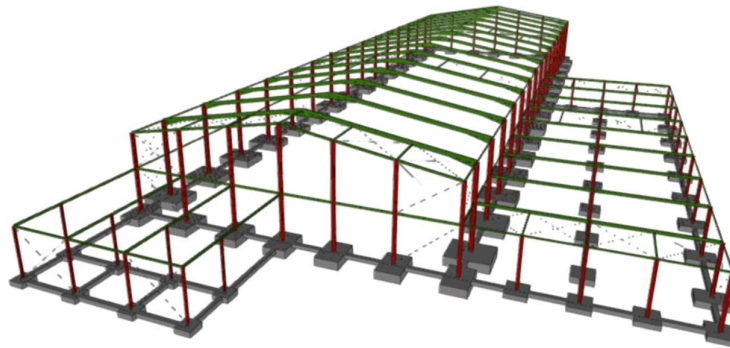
Vista 3D de la estructura metálica y la cimentación.
